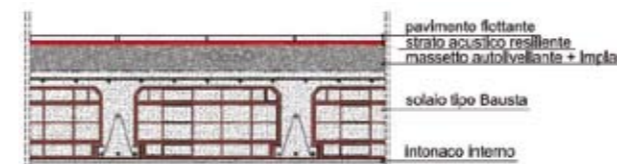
Lo strato acustico resiliente ed il pavimento flottante posato a secco.
